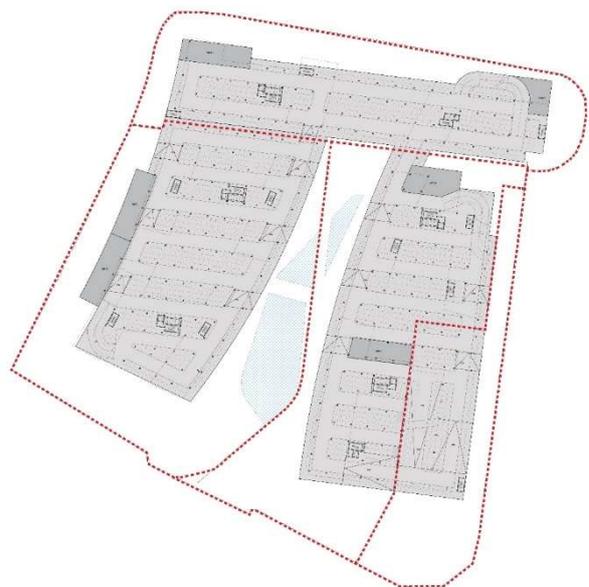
Geplante Untergeschoss/Tiefgaragenebene, Entwurfsverfasser Pickard Chilton, New Haven, Connecticut, Abdruck mit Genehmigung des Rechteinhabers P140 PropCo S.à.r.l., Luxemburg
